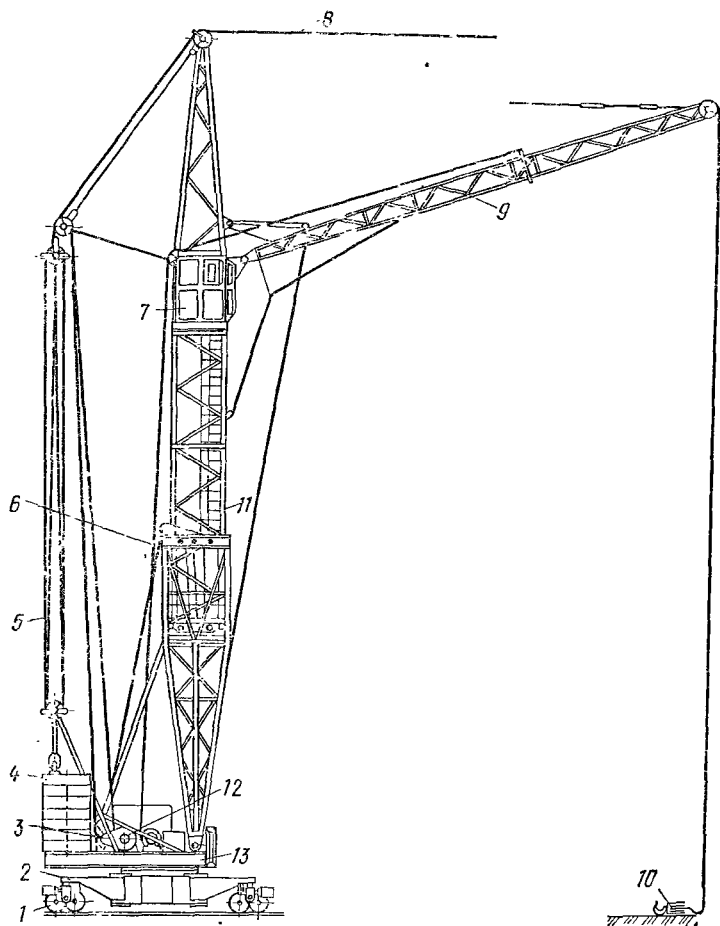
Башенный кран КБ-160.2Б с подвесной стрелой
